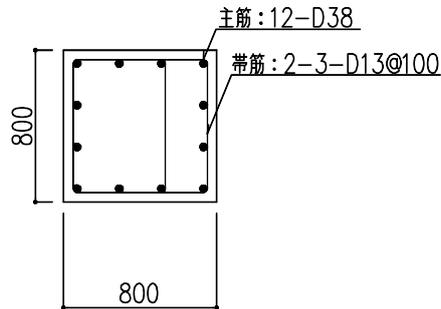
柱の配筋図 (地下2階, X4/YP 通り, 柱頭部) (単位:mm)
